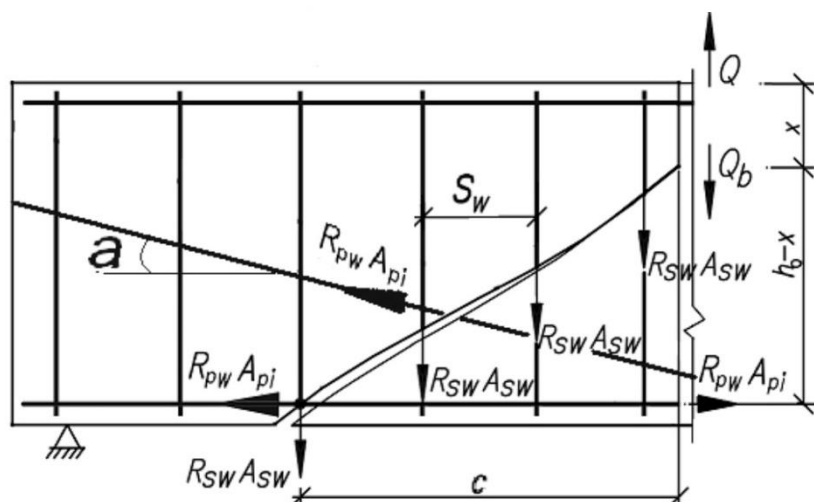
Схема расчета хомутов нормальных к оси балки
